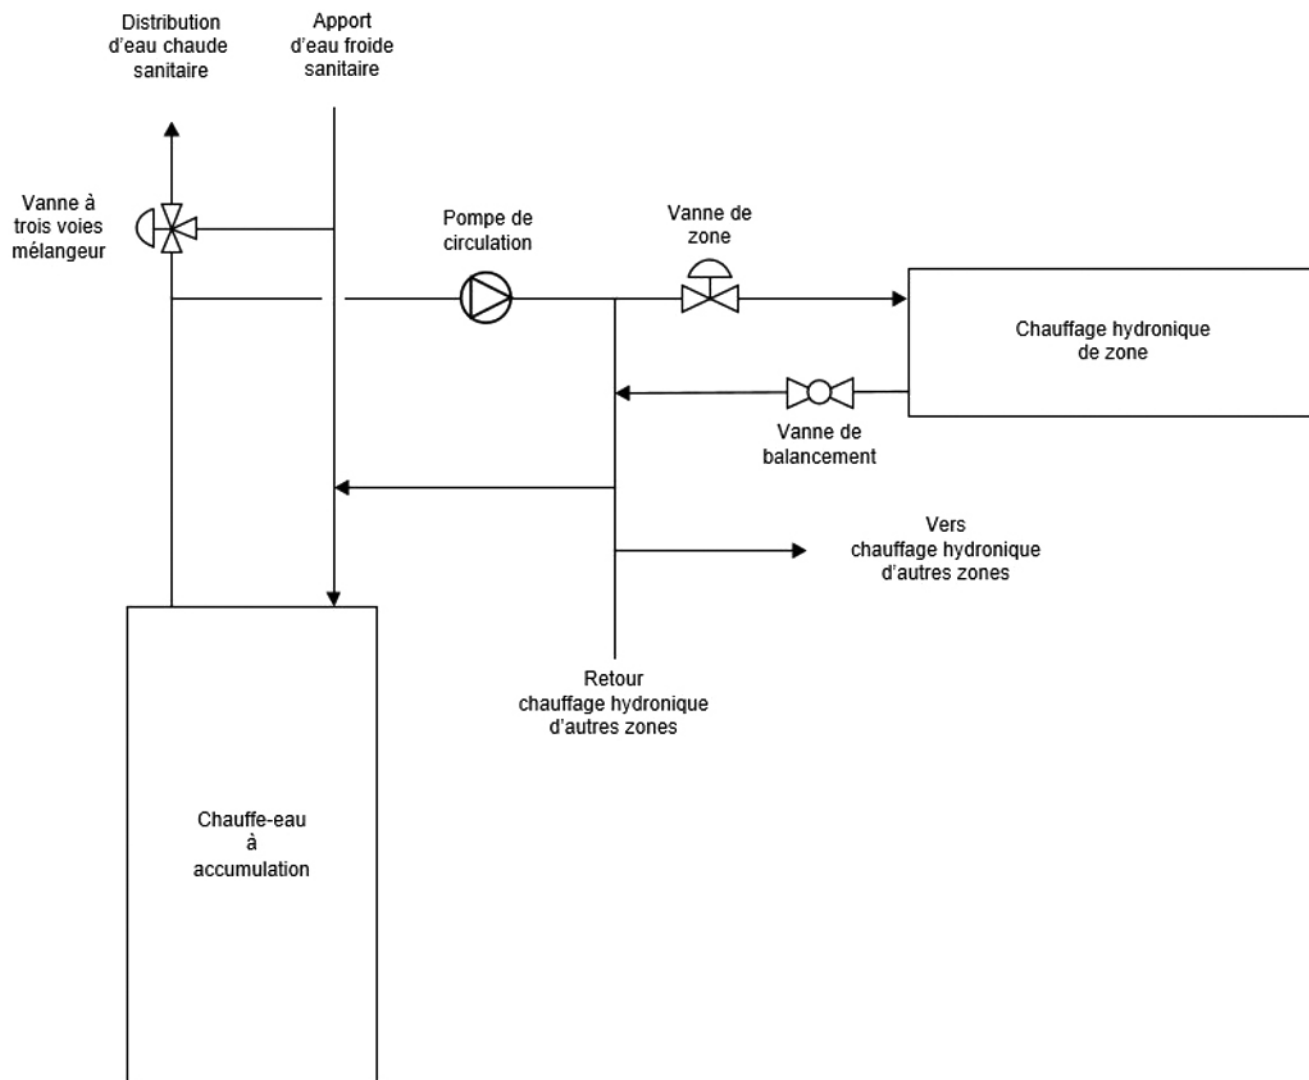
Installation mixte de chauffage des espaces et de l’eau sanitaire avec un chauffe-eau à accumulation
